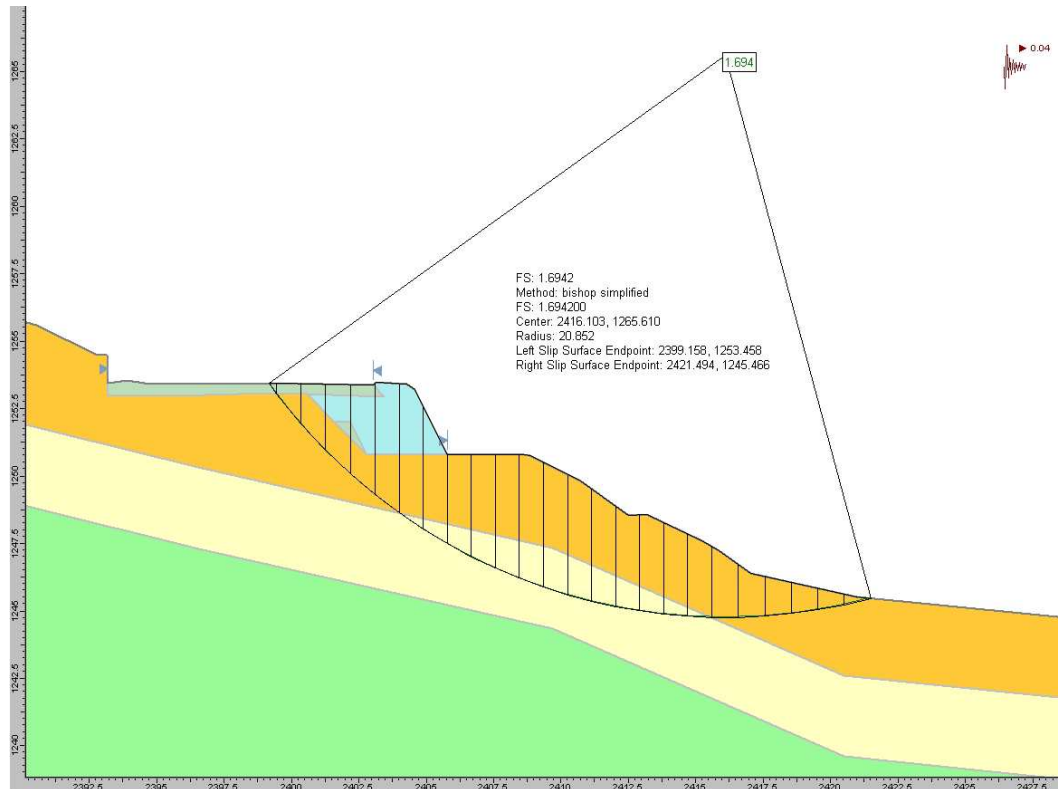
Muro MR02 – Sezione tipo – Condizioni sismiche
